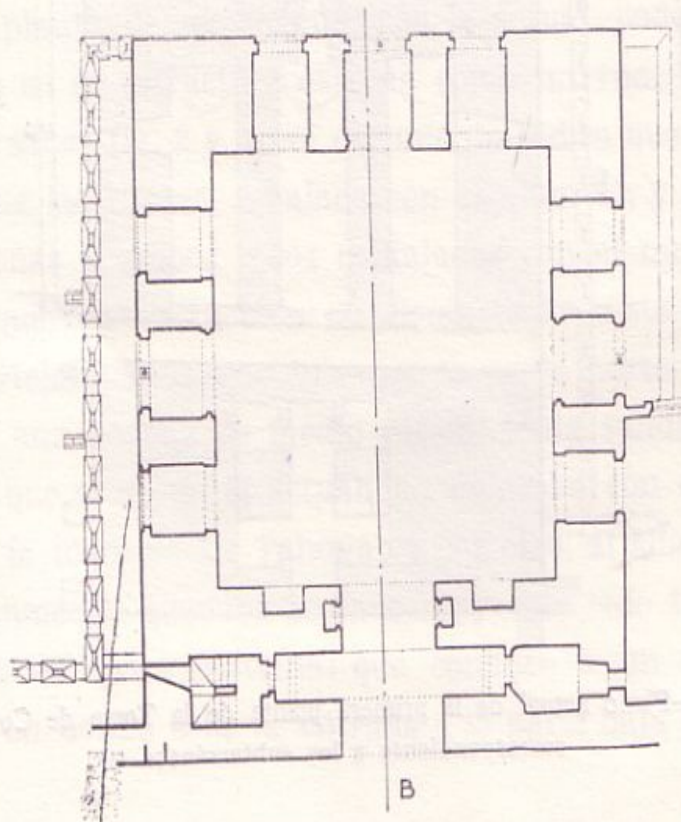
Plano de la 2.<sup>a</sup> planta, correspondiente al Salón de Embajadores, en su estado actual
